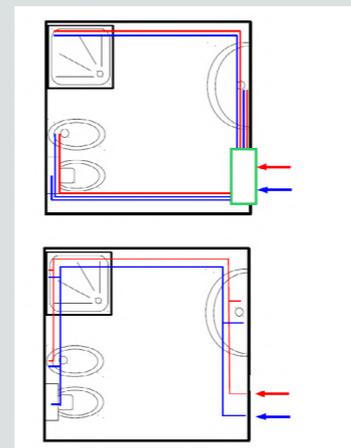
Distribuzione impianto idraulico senza accavallamenti e con un connettore (sopra), distribuzione impianto elettrico tradizionale (sotto). Fonte: Fedelegnoarredo, Manuale d'uso e manutenzione, guida fornita dall'Ingegnere Matteo Izzi, ufficio tecnico Assolegno, pg.24
